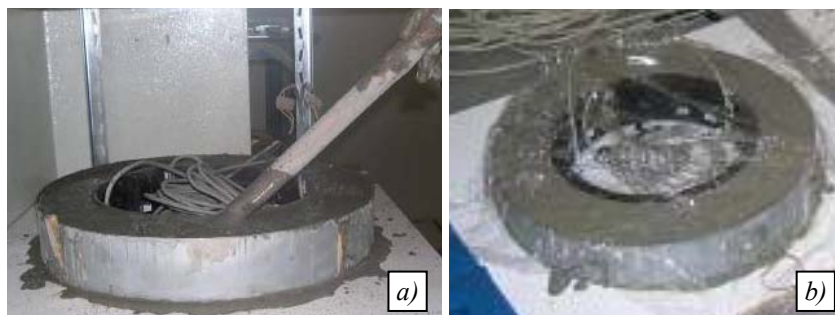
a) Vibração do anel de betão; b) Colocação do plástico de protecção
